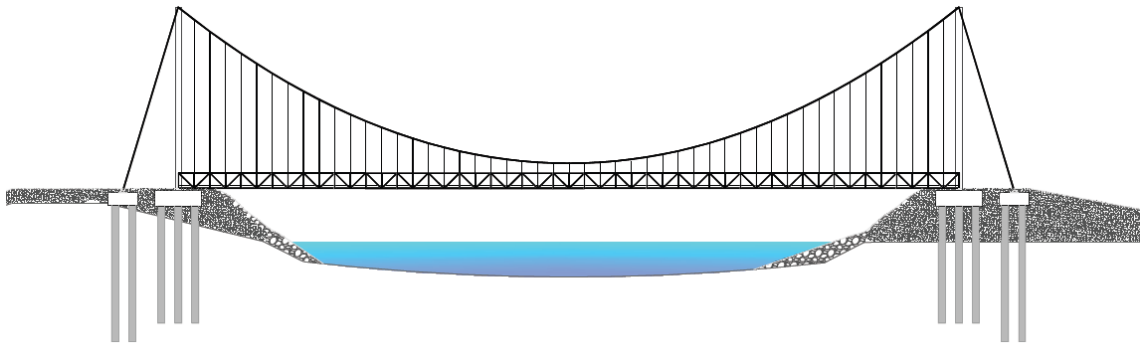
Esquema da Ponte - Corte longitudinal
